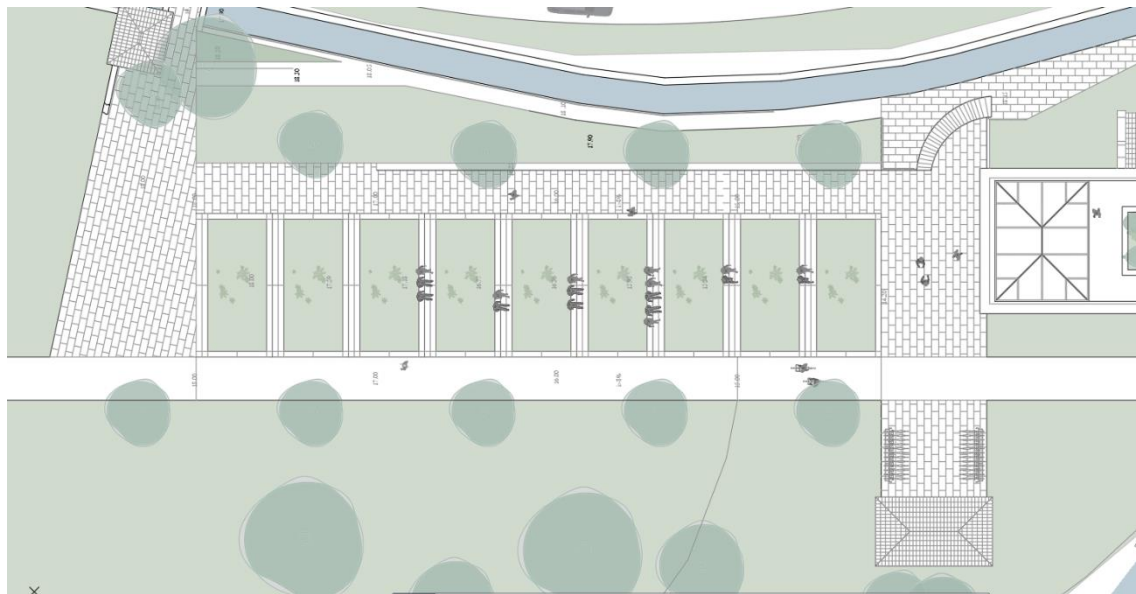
PC – Auditório da Central Elétrica, planta (elaborado pelo autor)
